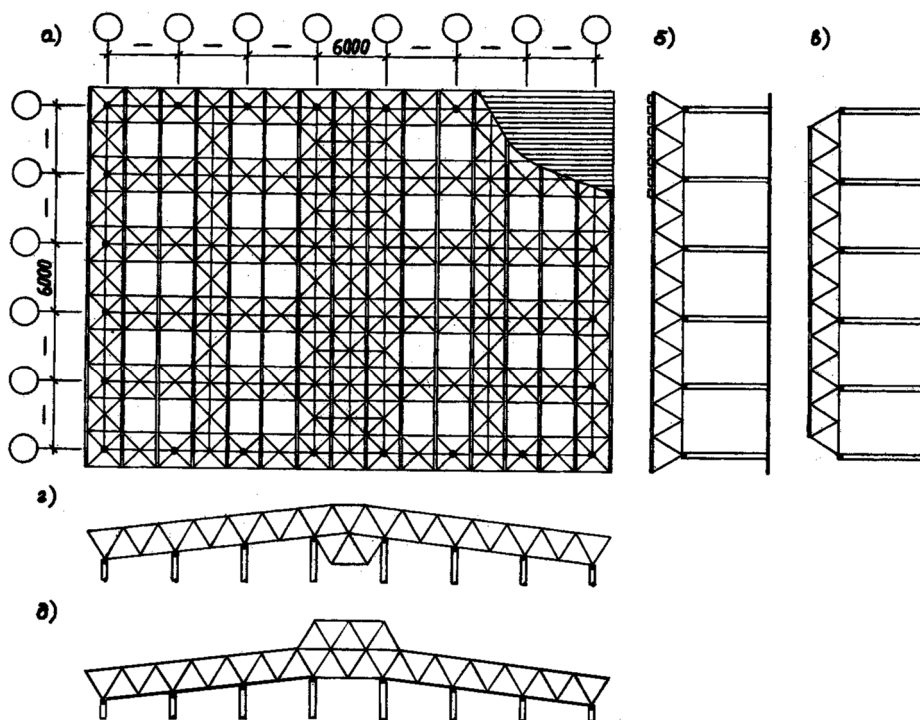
Схемы большепролетного пространственно-стержневого покрытия: *а* – план (общий вид); *б* – консольное опирание; *в* – бесконсольное опирание; *г* – подстропильно-бесфонарная конструкция; *д* – подстропильно-фонарная конструкция
